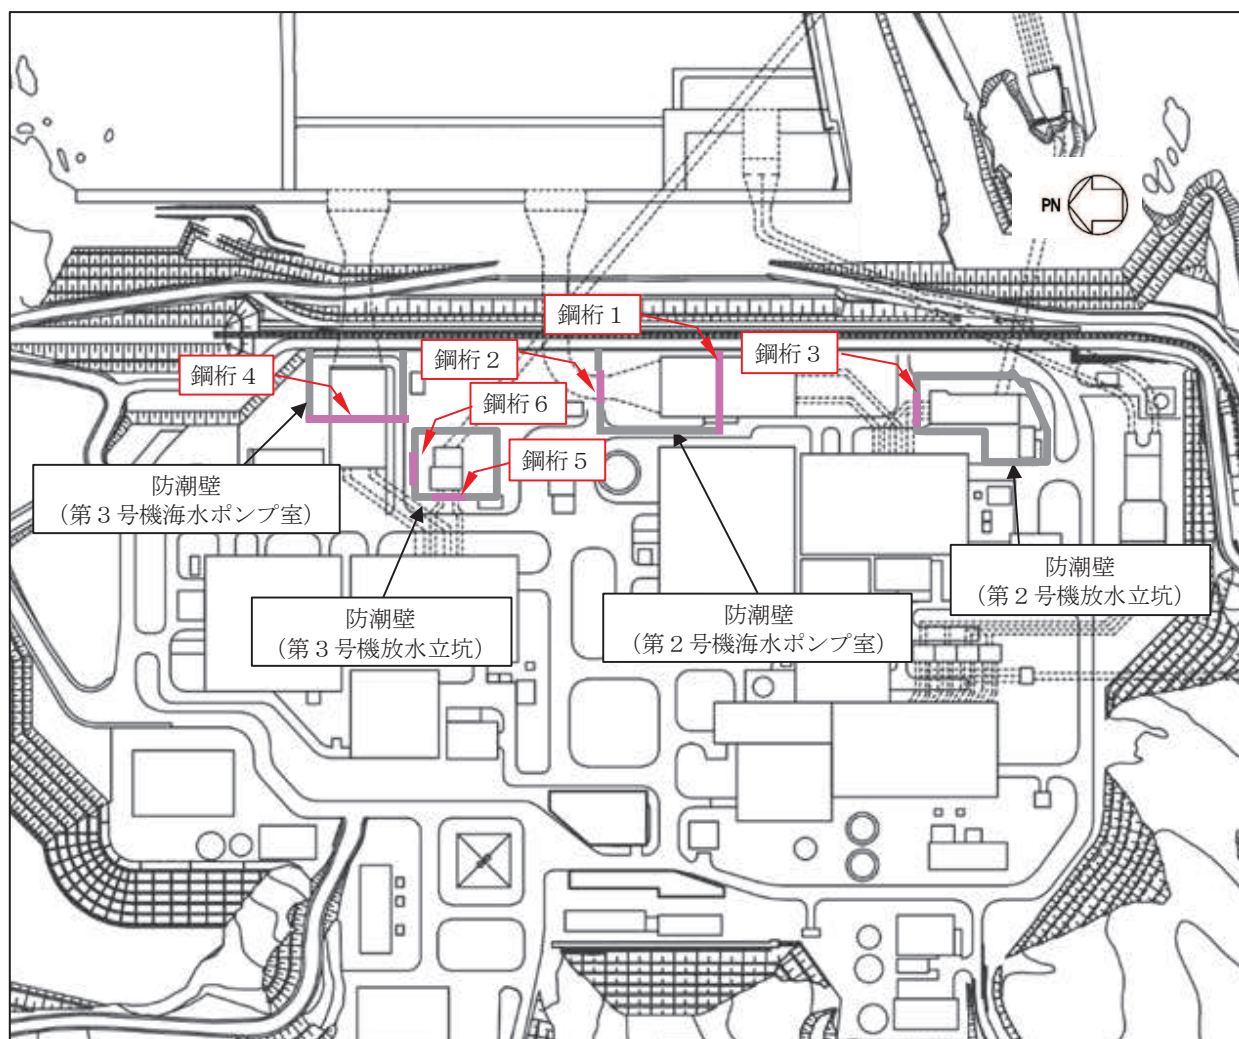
鋼製遮水壁（鋼桁）の配置図
